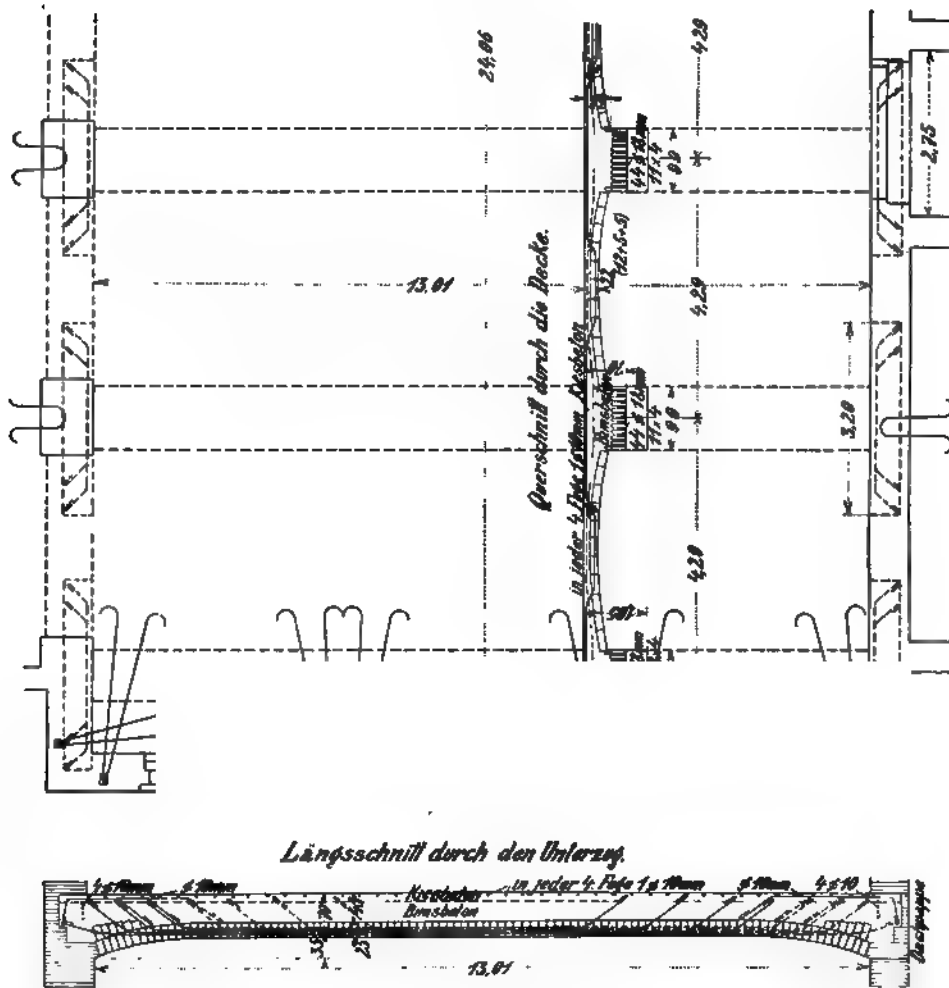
u. 303. Ausführung der Eggertdecke über der Turnhalle des Gymnasiums in Groß-Lichterfelde.
